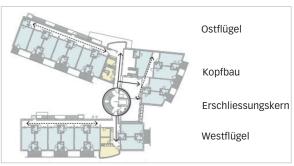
Situationsplan mit Haupteingängen und raumbildenden Kanten, Schema und Bezeichnung der Gebäudekomponenten (Quelle: Werk 32 GmbH)
